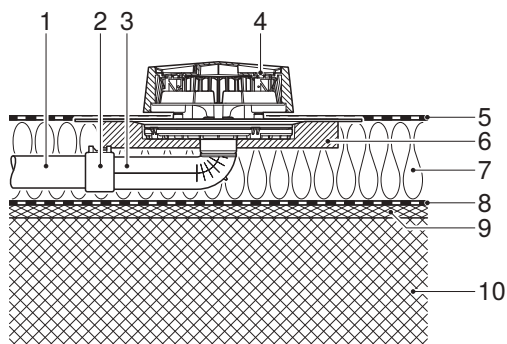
Montage dans toiture massive isolée avec sortie horizontale dans l'isolation thermique, revêtement d'étanchéité et pare-vapeur
